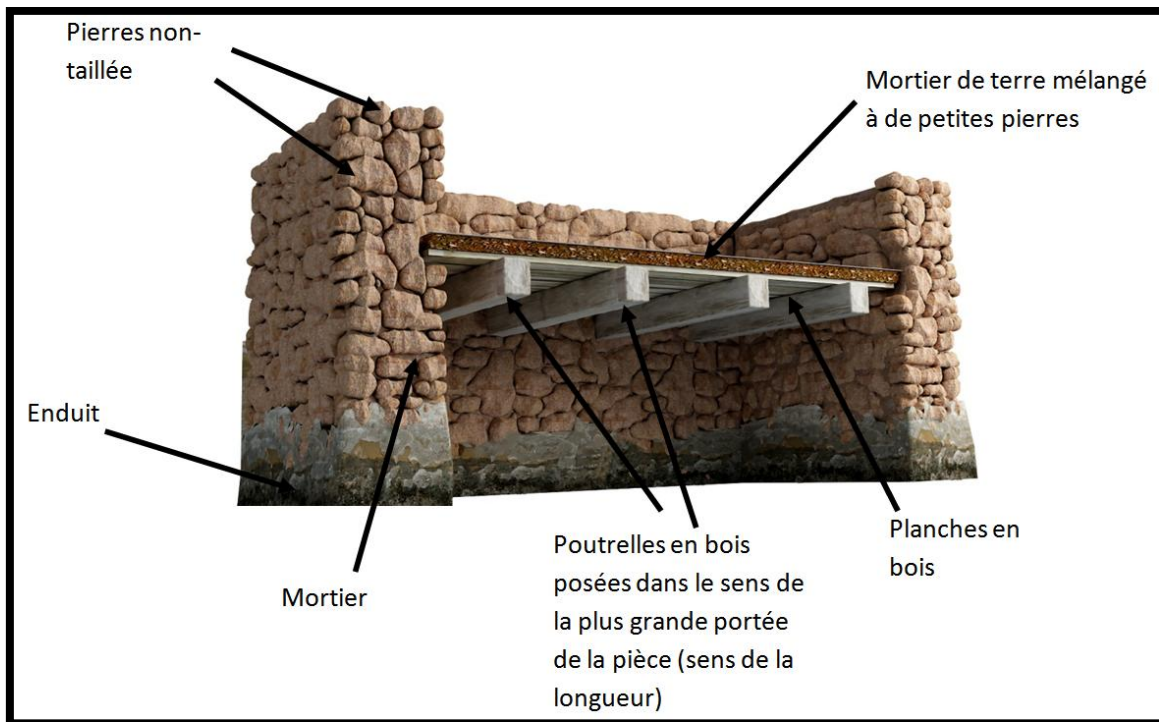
Typologie constructive d'un plancher en poutrelles en bois<sup>105</sup>
